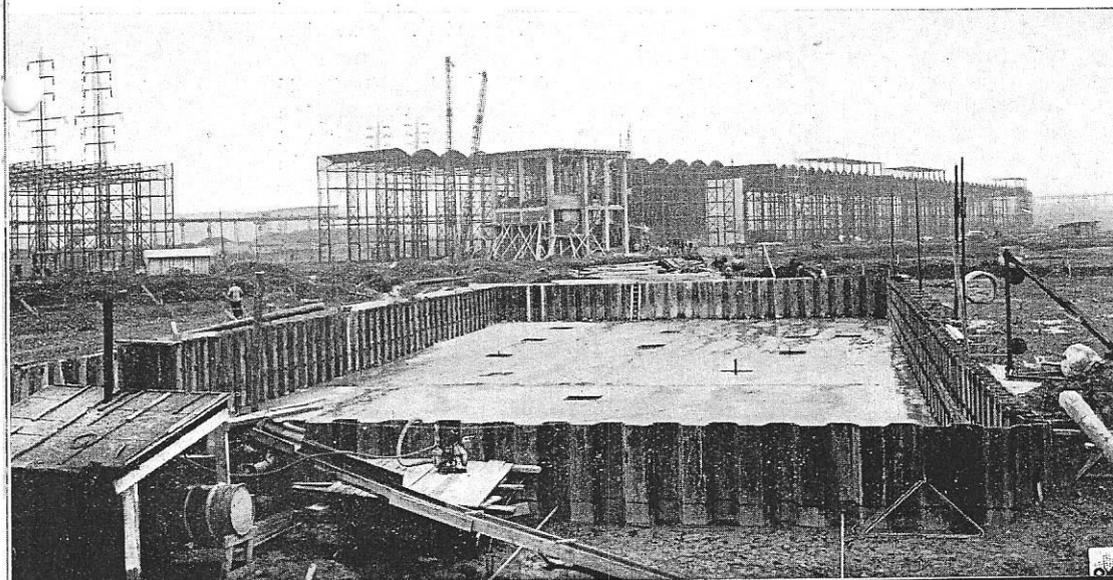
Vue prise en novembre 1938. Au premier plan, les parois en palplanches métalliques de la future piscine olympique du Lido. A l'arrière-plan, les charpentes standard des palais de la Section belge.
